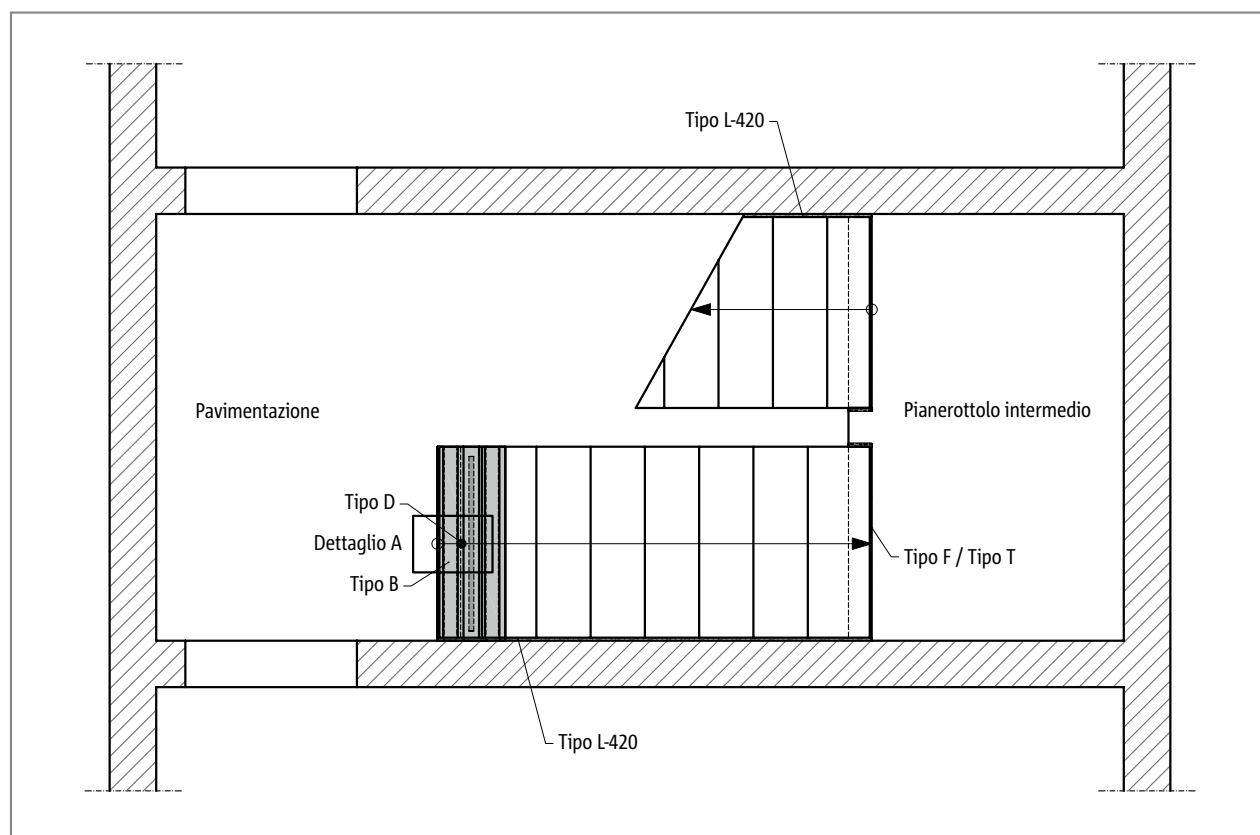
Schöck Tronsole® tipo B + tipo D: disposizione dell'elemento nella pianta
